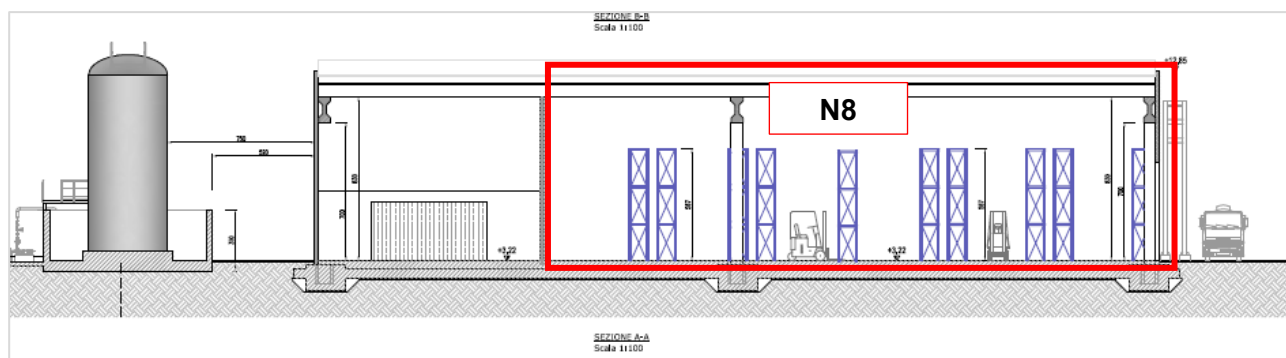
Prospetto A-A (Stralcio elaborato CO 05 RA VA 01 D1 PL 65.00 - N8-N10 PROSPETTI E SEZIONI)
